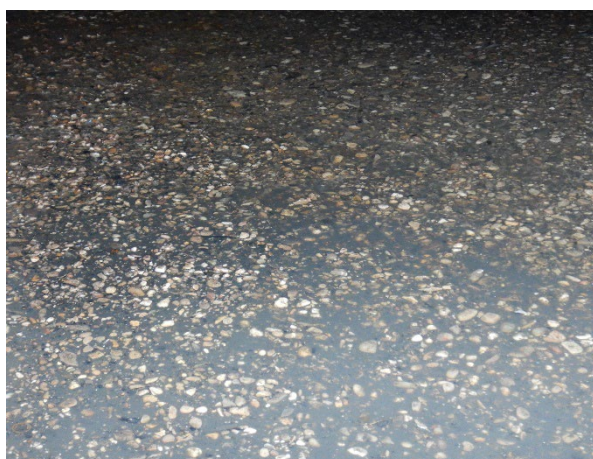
Vloeroppervlak sterk aangetast, wapening lokaal zichtbaar.
